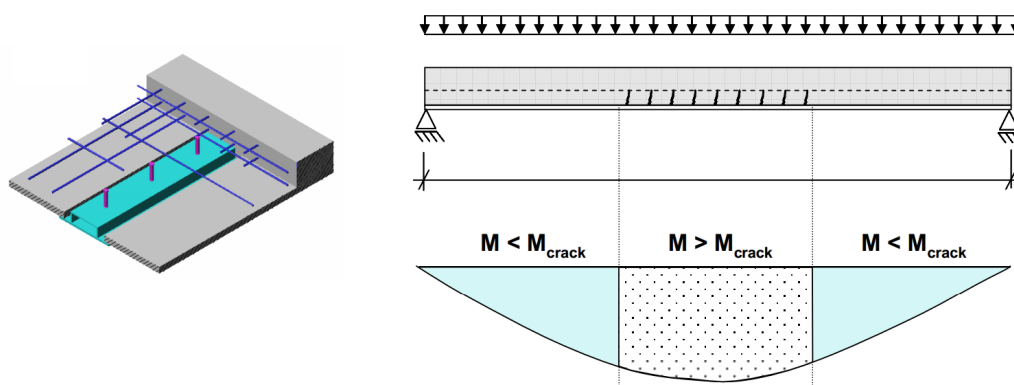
Comportamento de viga *slimfloor* sob momento positivo (adaptado de Kuhlmann e Hauf, 2008)
